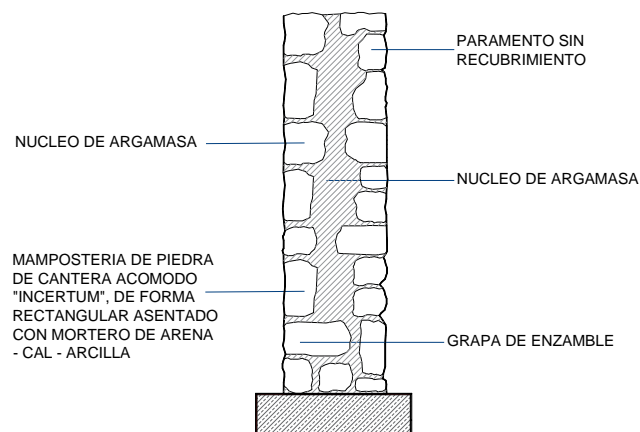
Detalle del muro de mampostería de cantera.
